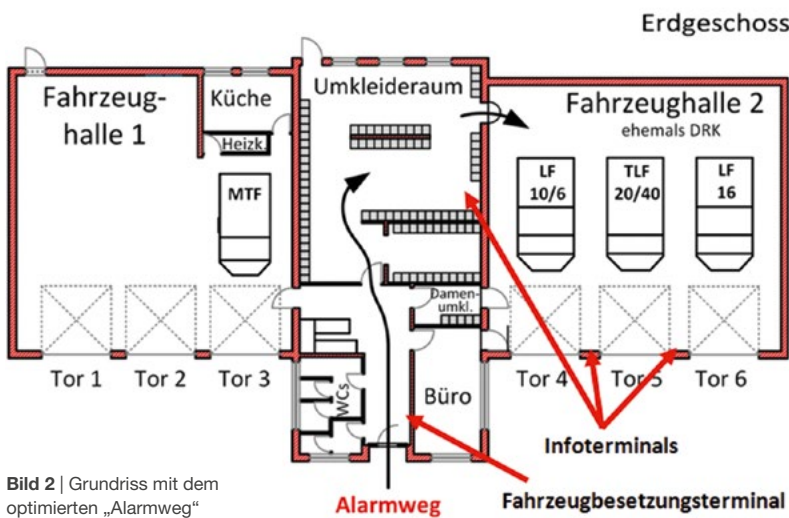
| Grundriss mit dem optimierten „Alarmweg“
